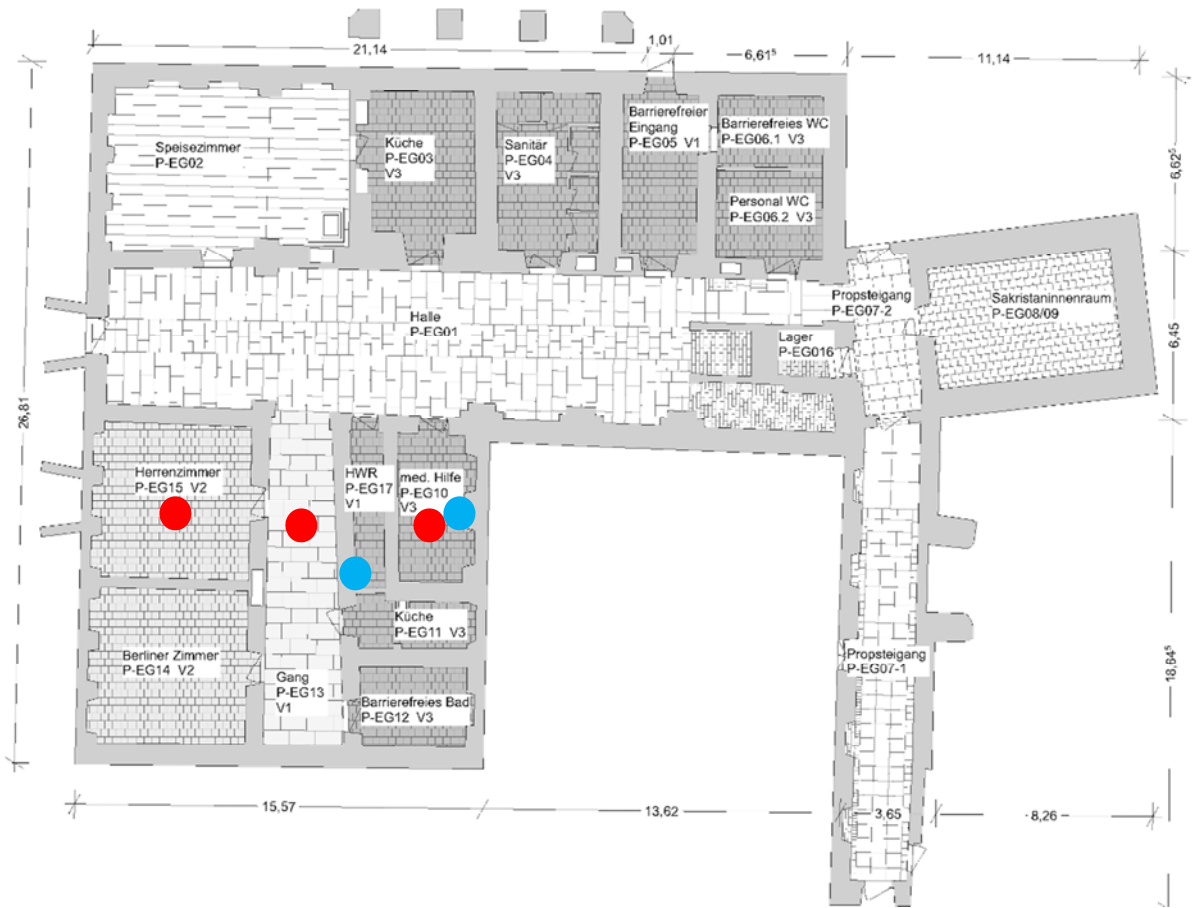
Grundriss der Propstei mit den Messpunkten für die Klimaentwicklung im Fußboden (rote Punkte) und Wandbereichen (blaue Punkte)
